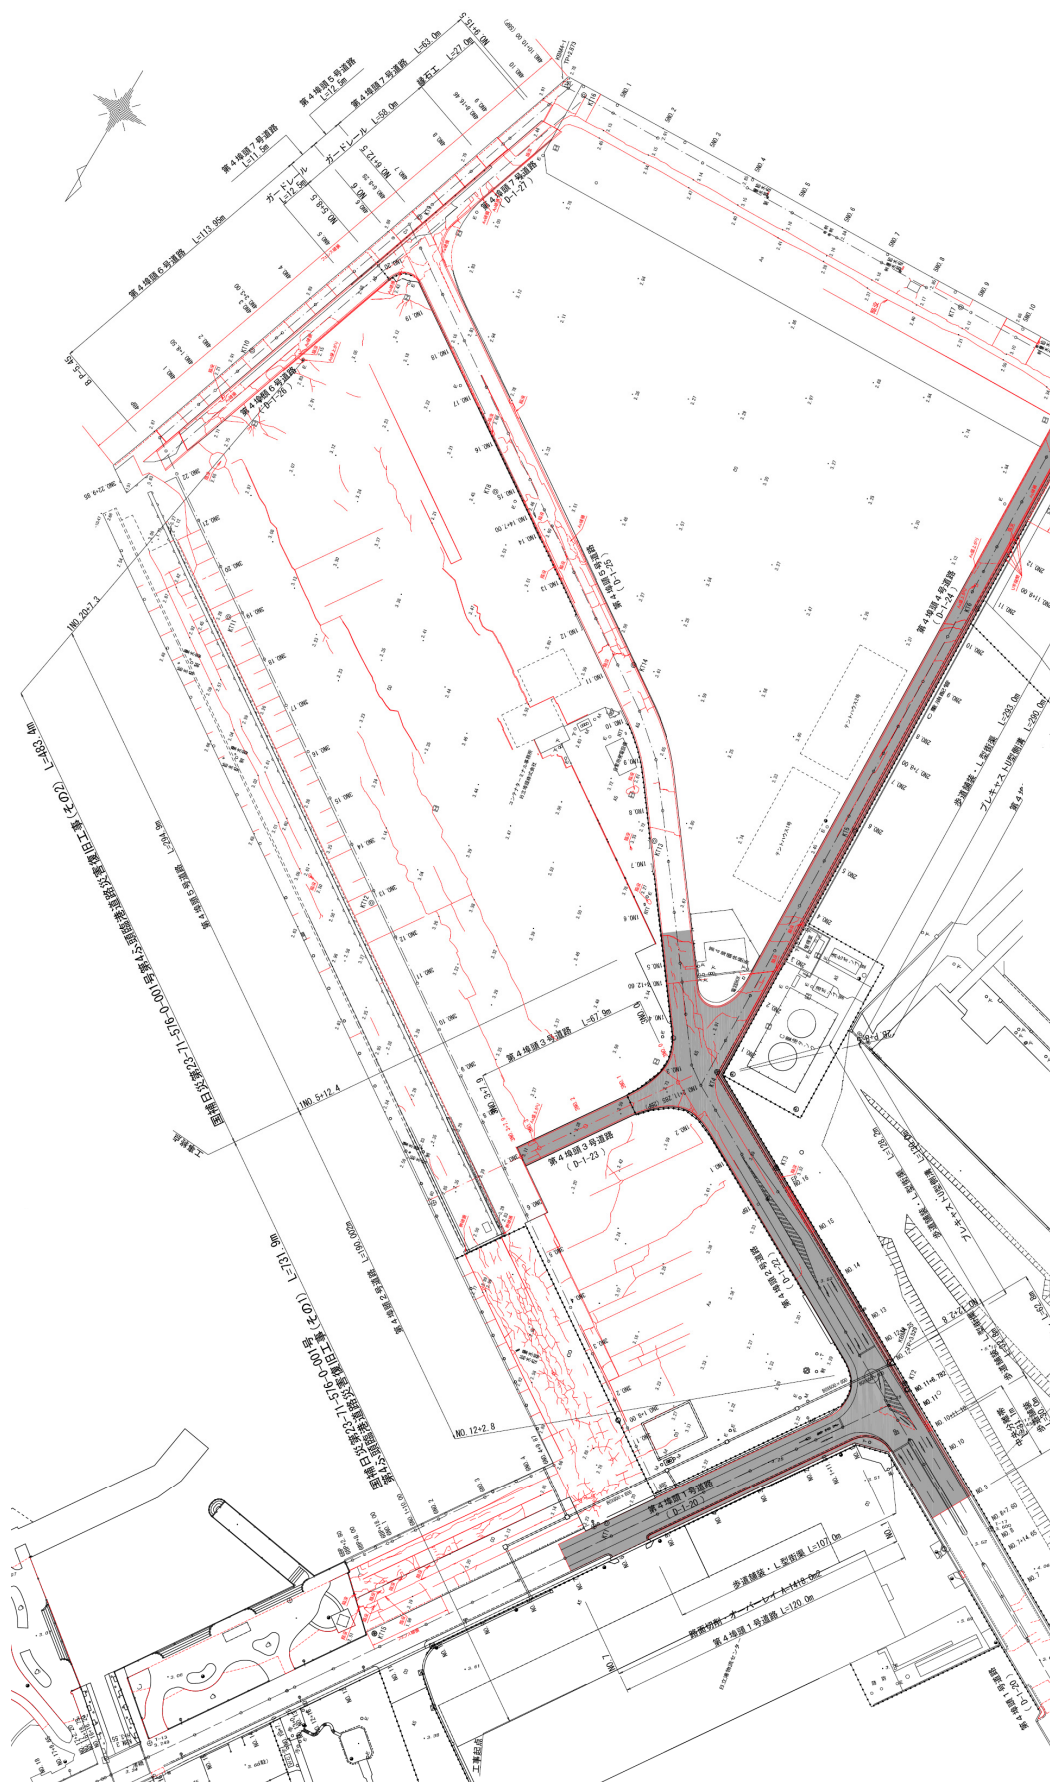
No.7 日立港区\_第4埠頭1号~7号道路の平面図(復旧後)
